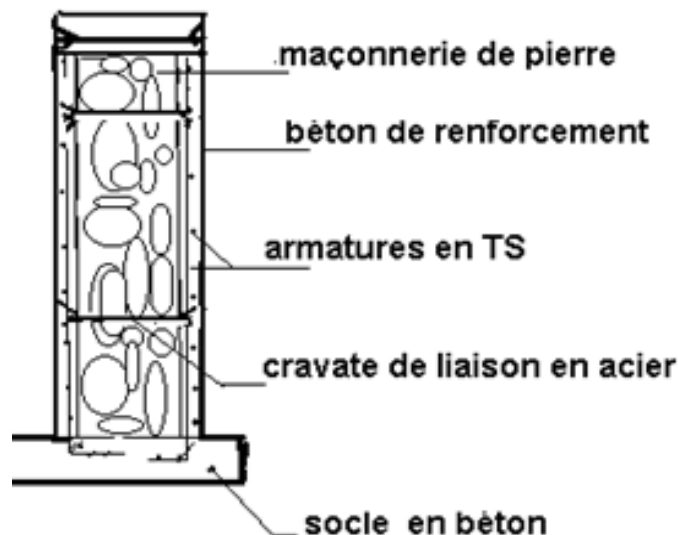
Renforcement de la maçonnerie par projection de couches de béton
